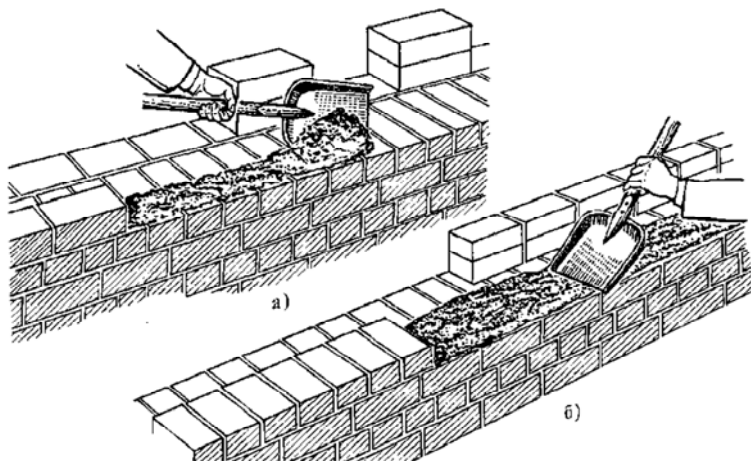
Расстиление и разравнивание раствора лопатой совковой: а – для ложкового ряда; б – для тычкового ряда
